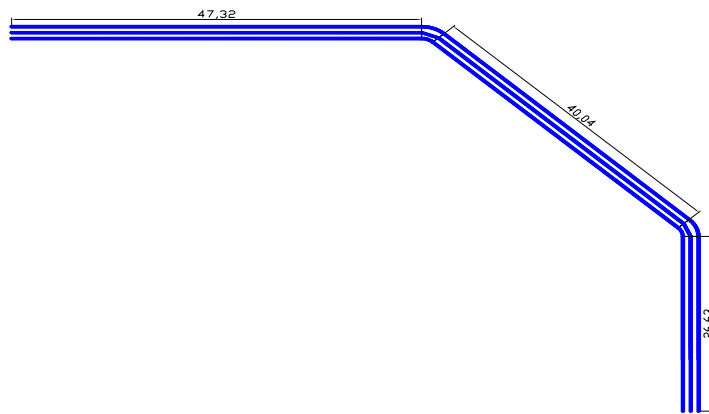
Vista en planta de la tubería de conexión con dos codos de 45°
